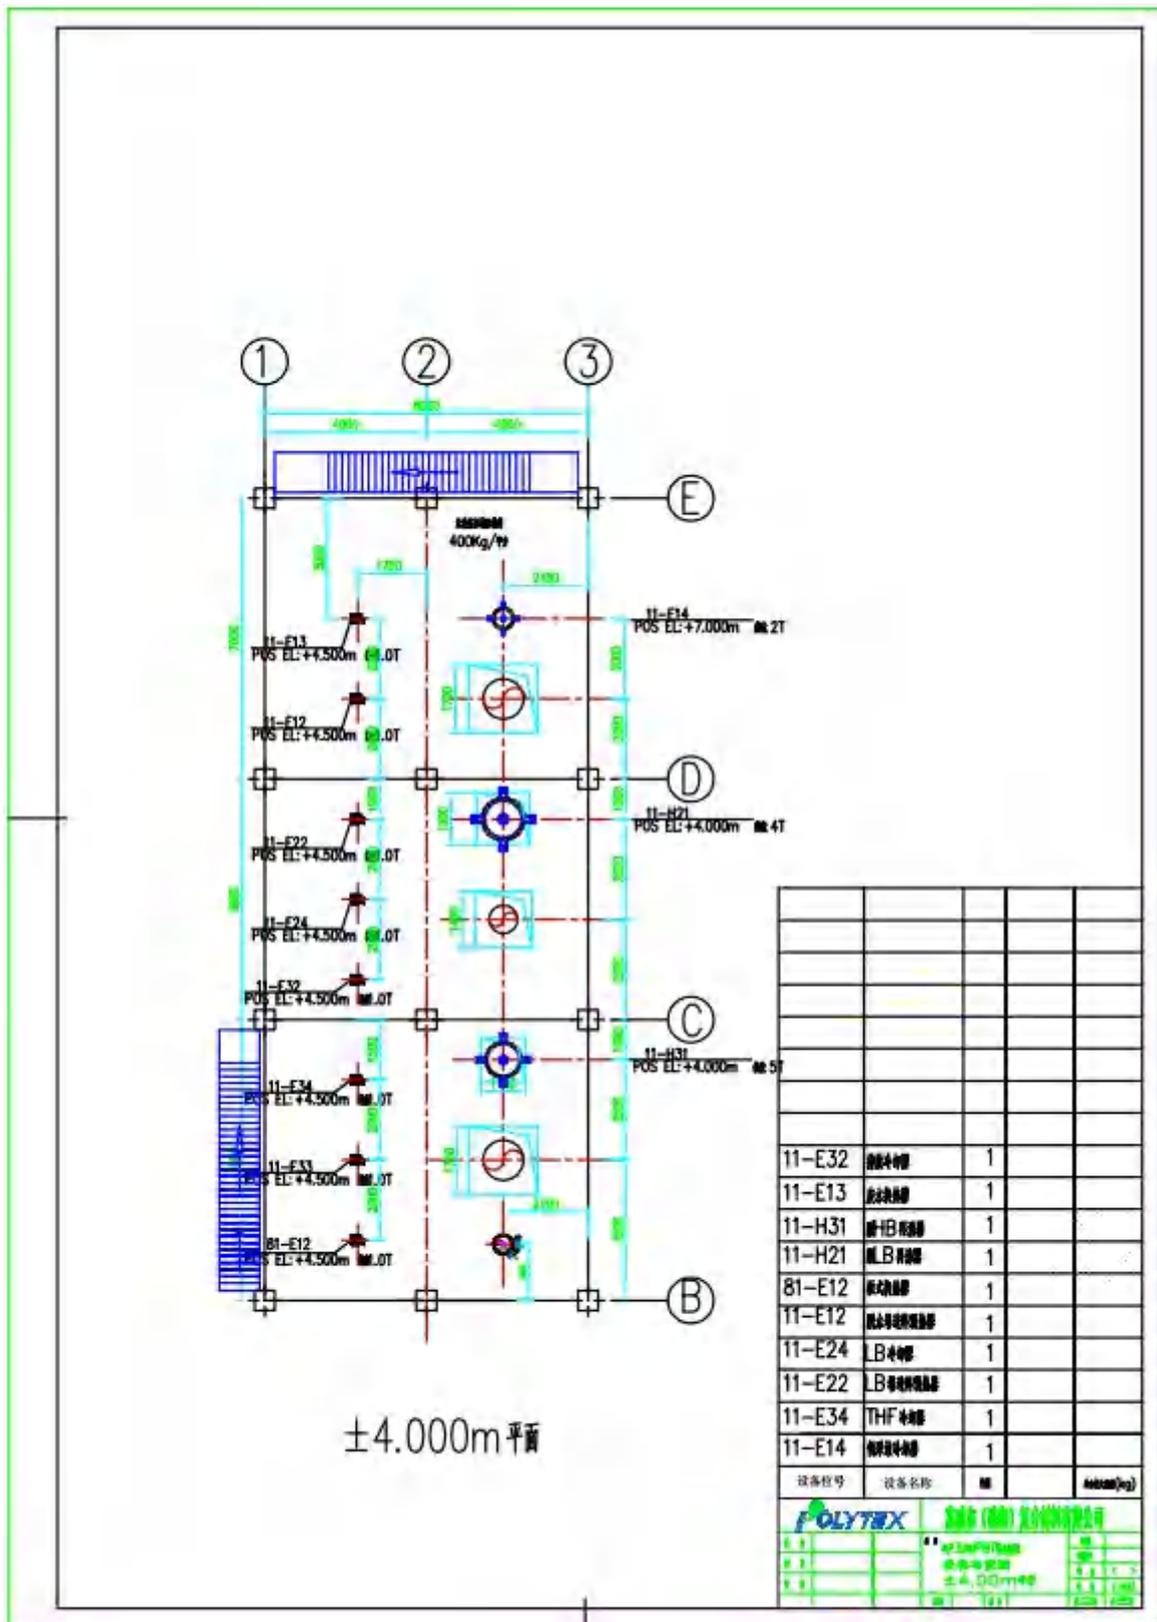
项目 THF 回收系统设备布置图 (4m)
